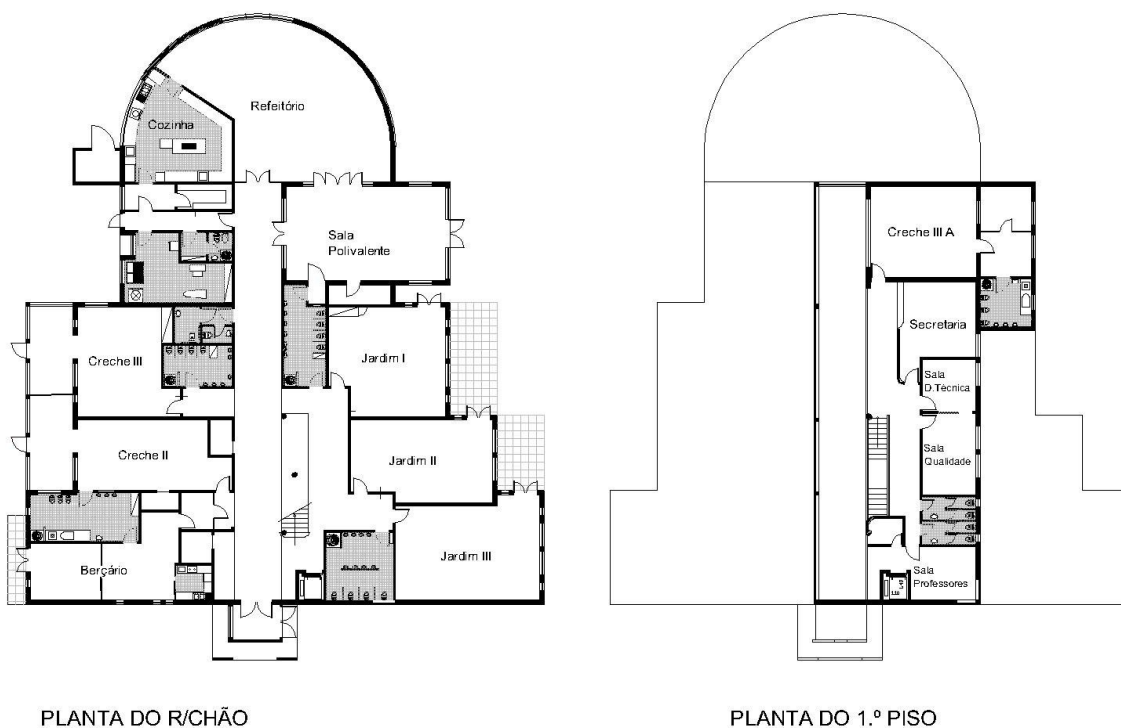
Planta do R/Chão e 1ºPiso do edifício
